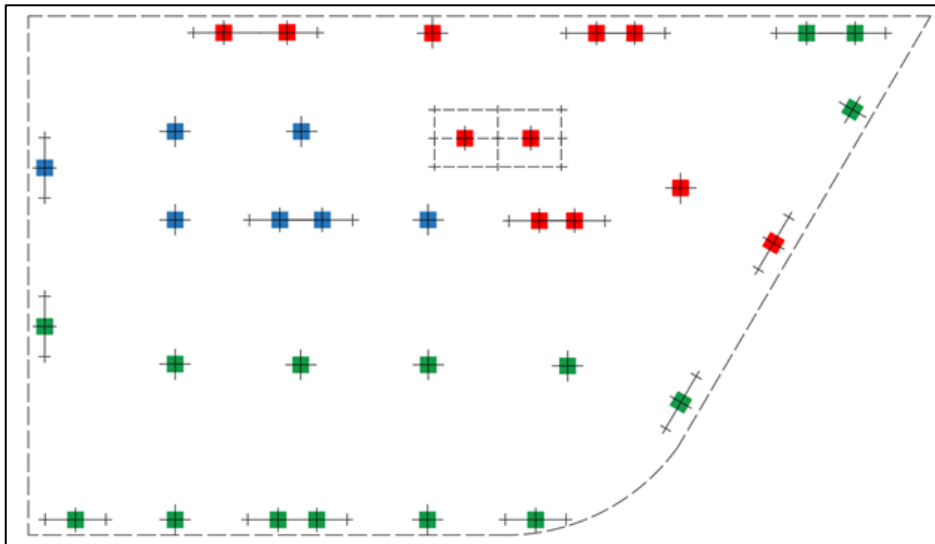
Ubicación en planta de los distintos tipos de aisladores
